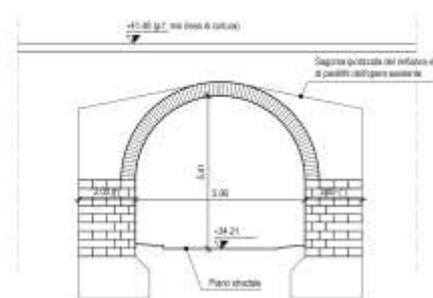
Sottovia ferroviario via Colombo, stato di fatto: prospetto sud e sezione trasversale
